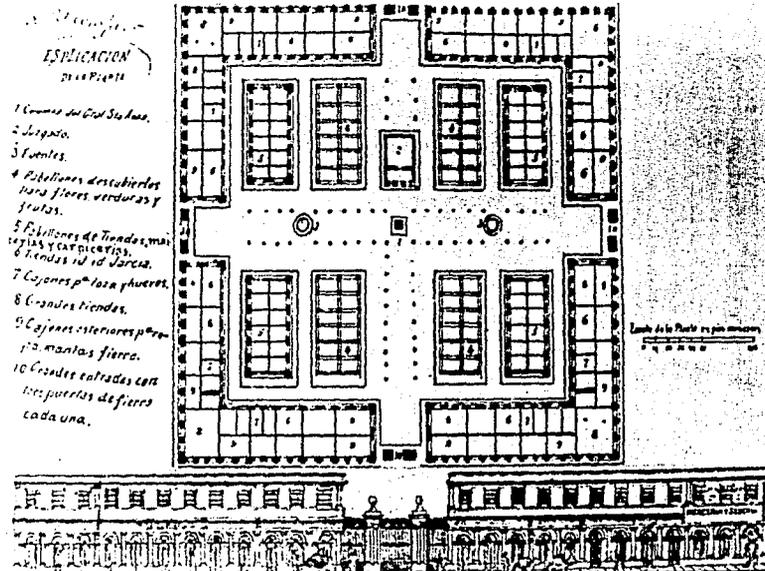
Planta y fachada hacia la calle de Flamencos del mercado del Volador
